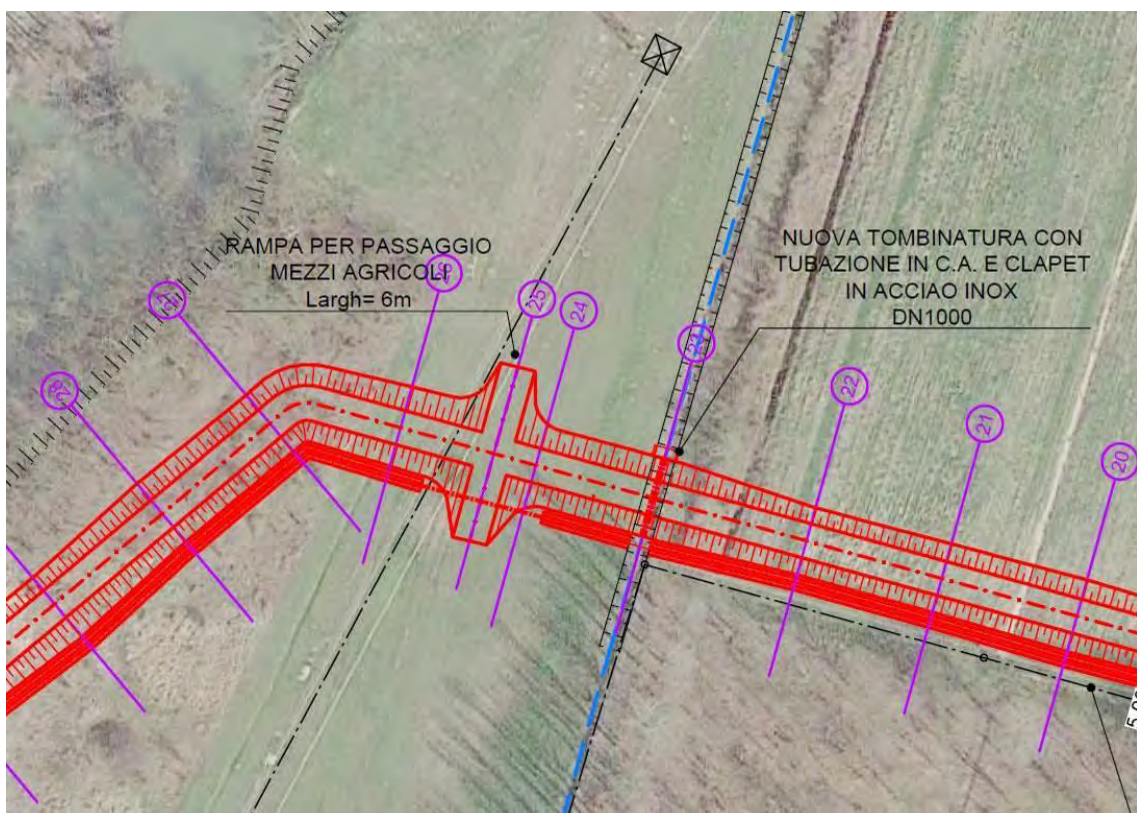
posizione fosso di scolo interferente con l'argine in progetto (stralcio planimetria di progetto).
